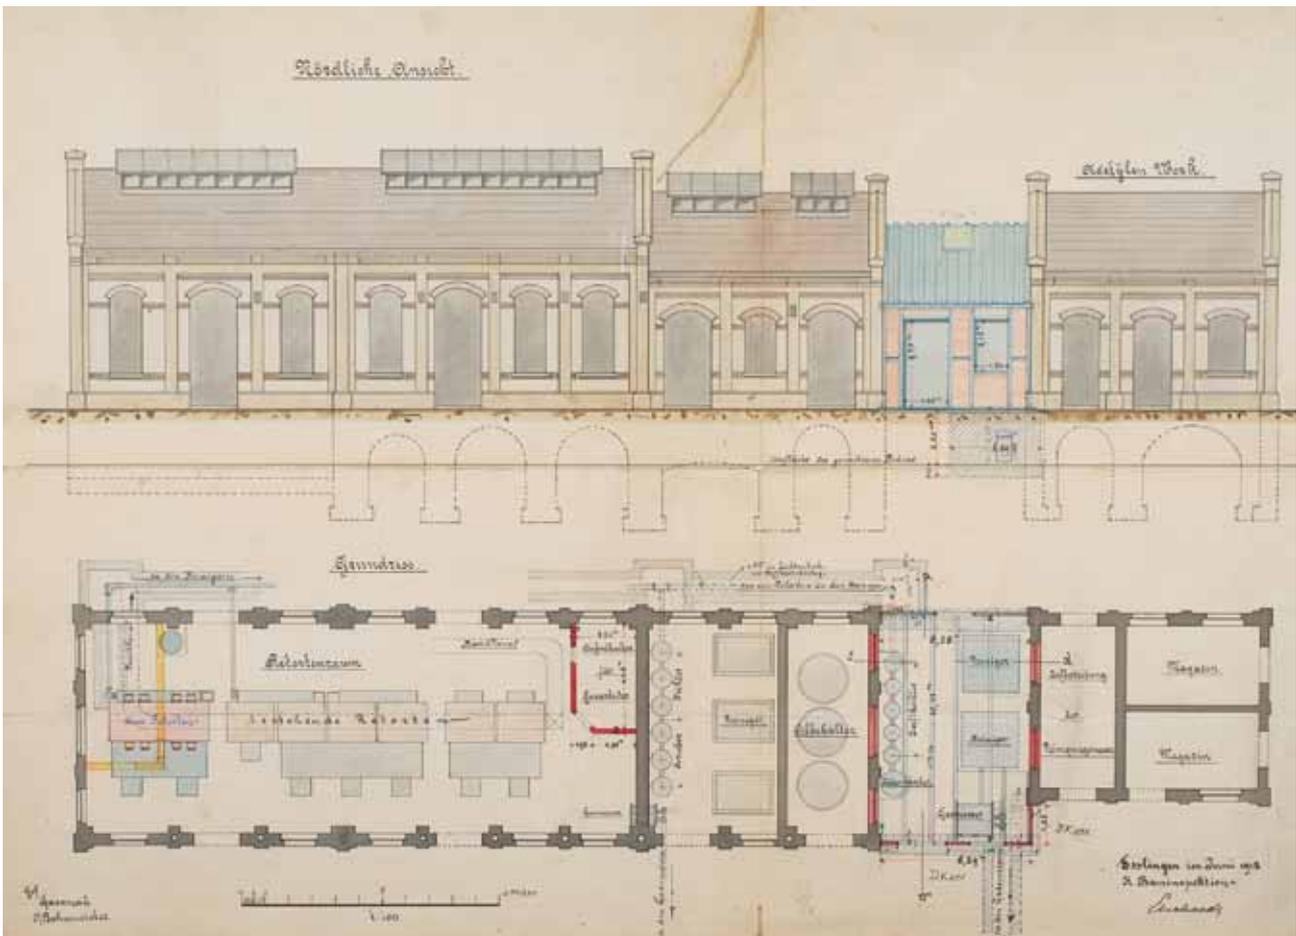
Erweiterung des Gaswerks 1912 - Seitenansicht sowie Anlagenteile des Retortenhauses.
